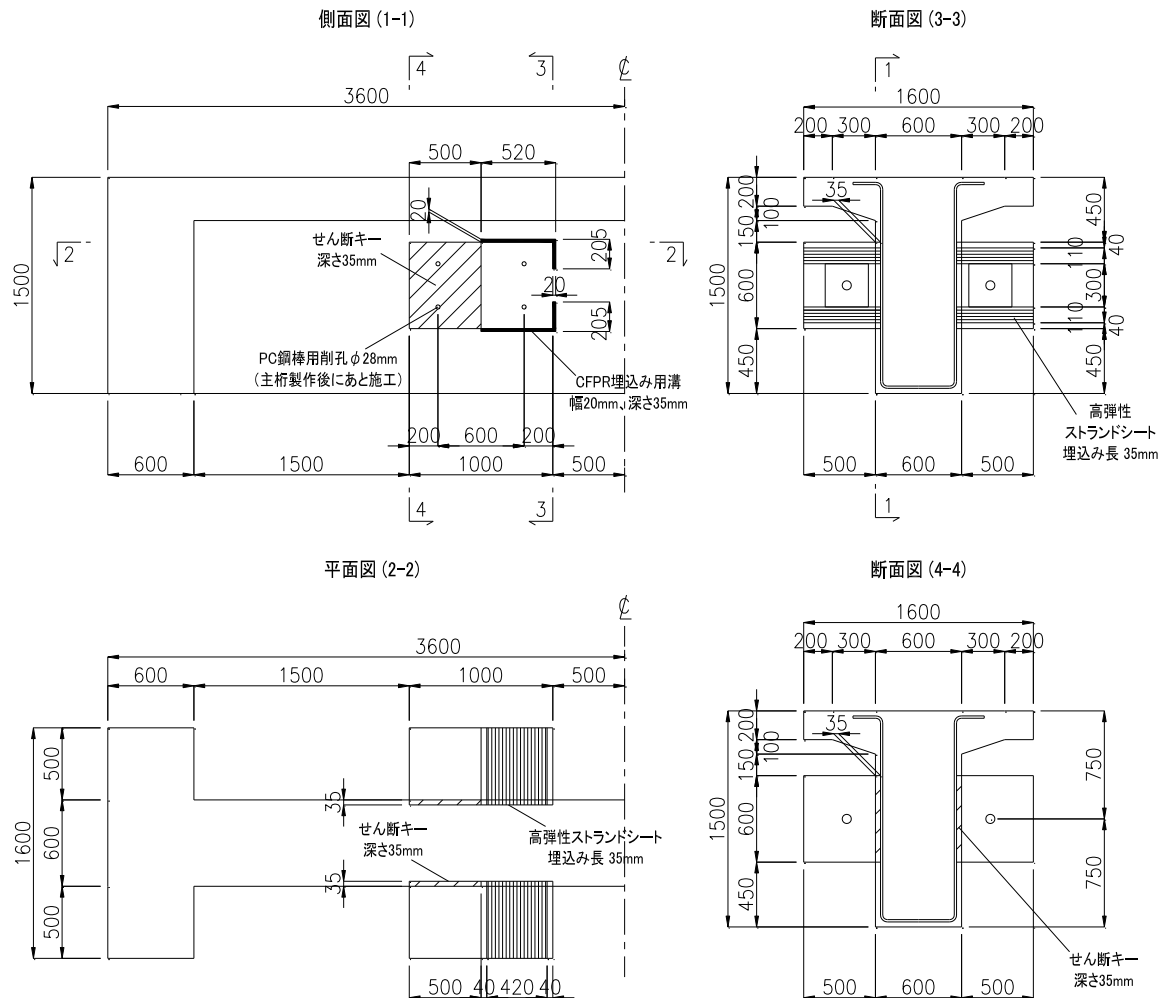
中型ブラケット試験体 せん断キーおよび CFRP 配置図 (単位:mm)
